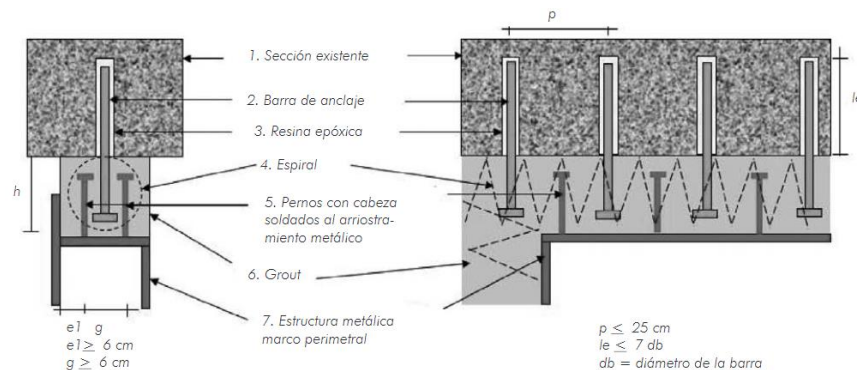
Detalle de la conexión indirecta. Fuente: (Rendón, 2007)
